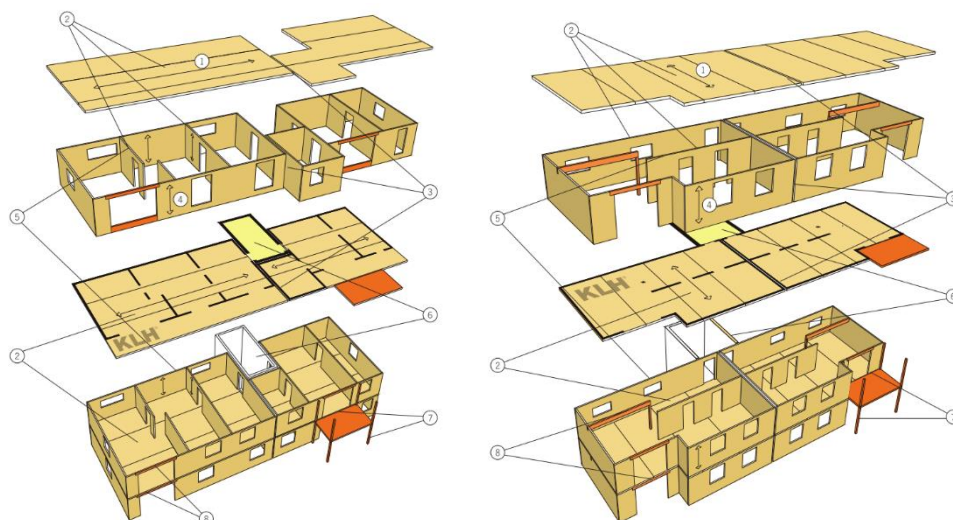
Variação da aplicação dos painéis de pavimento e tecto em apartamentos (KLH, 2011).
